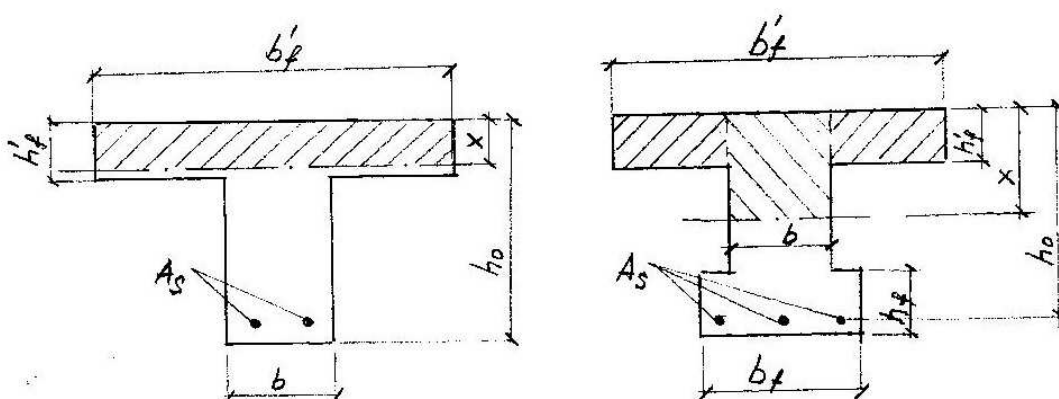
Таврові (двотаврові) перерізи. Випадки розташування нейтральної осі
